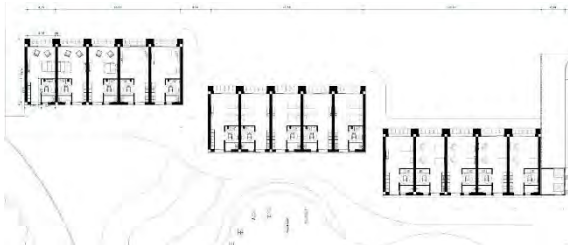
Planta Pavimento Tipo das unidades habitacionais.
